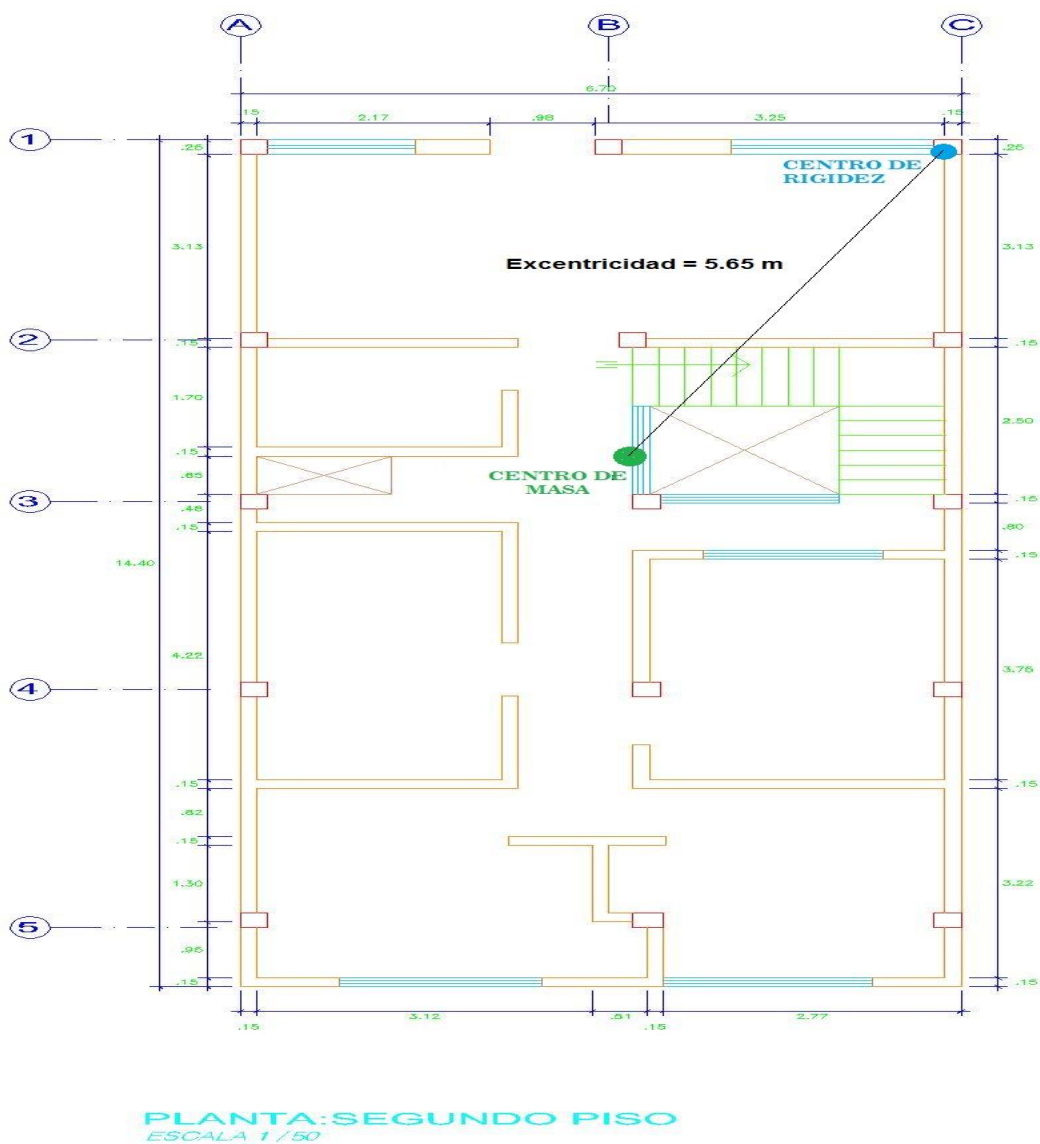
Ubicación del centro de masa y centro de rigidez en el plano de vista en planta del segundo piso (Fuente: Elaboración propia)
